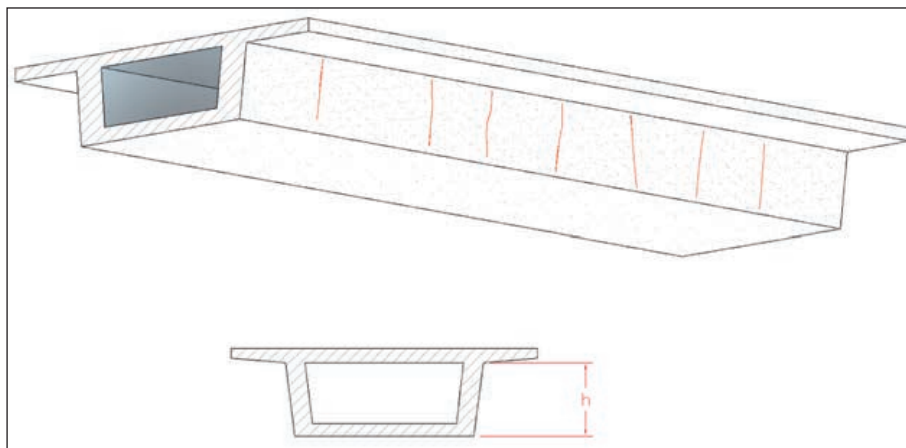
FISURAS DE RETRACCIÓN HIDRÁULICA DIFERENCIAL EN LAS ALMAS. NORMALMENTE DESAPARECEN ANTES DE LLEGAR A LAS LOSAS SUPERIOR E INFERIOR.
